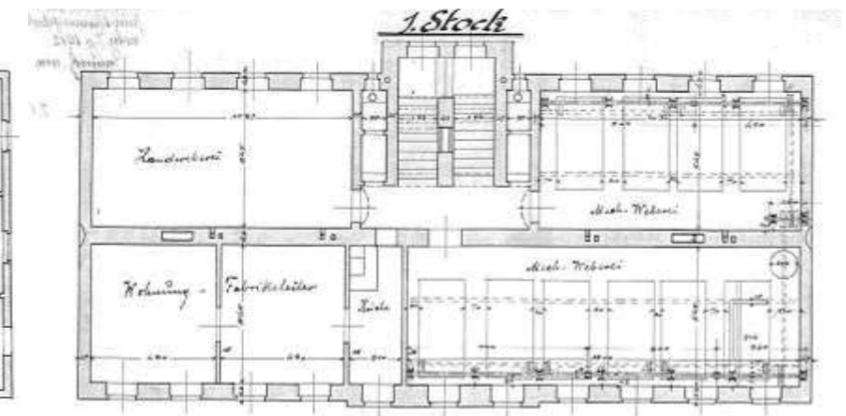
Wohnhaus (1.Obergeschoss) – Einreichplan 1912
